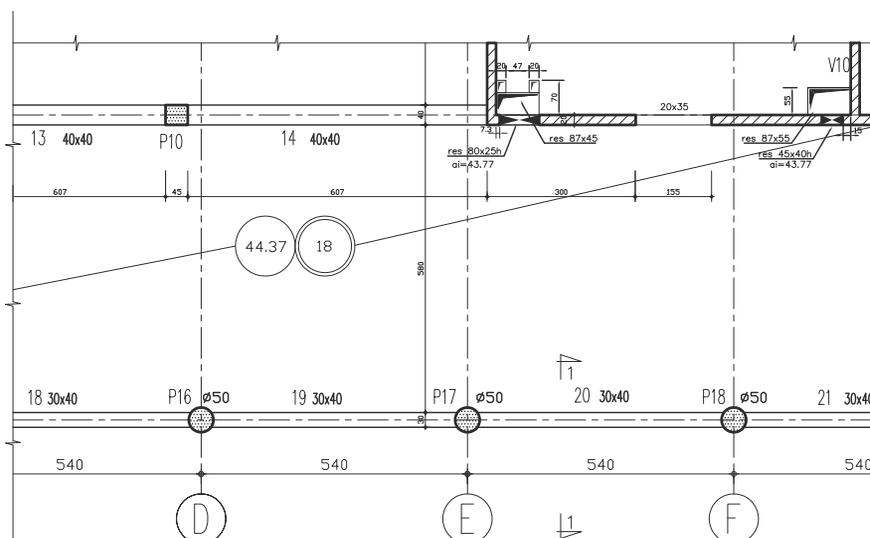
plan de coffrage du plancher haut du RDC, cotation en cm
